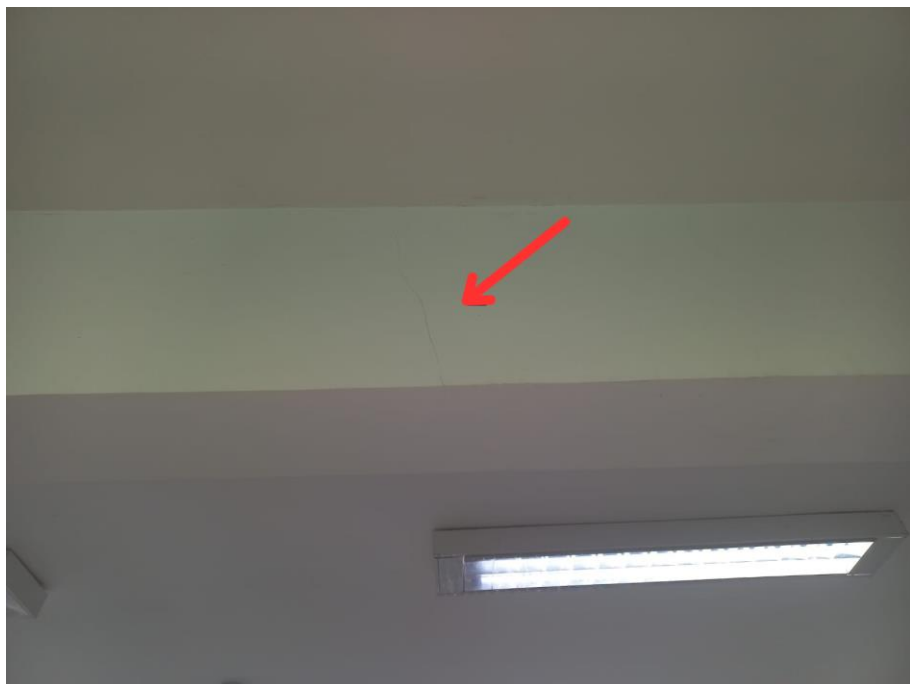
Fissura no centro da viga V52 Vão 4.
